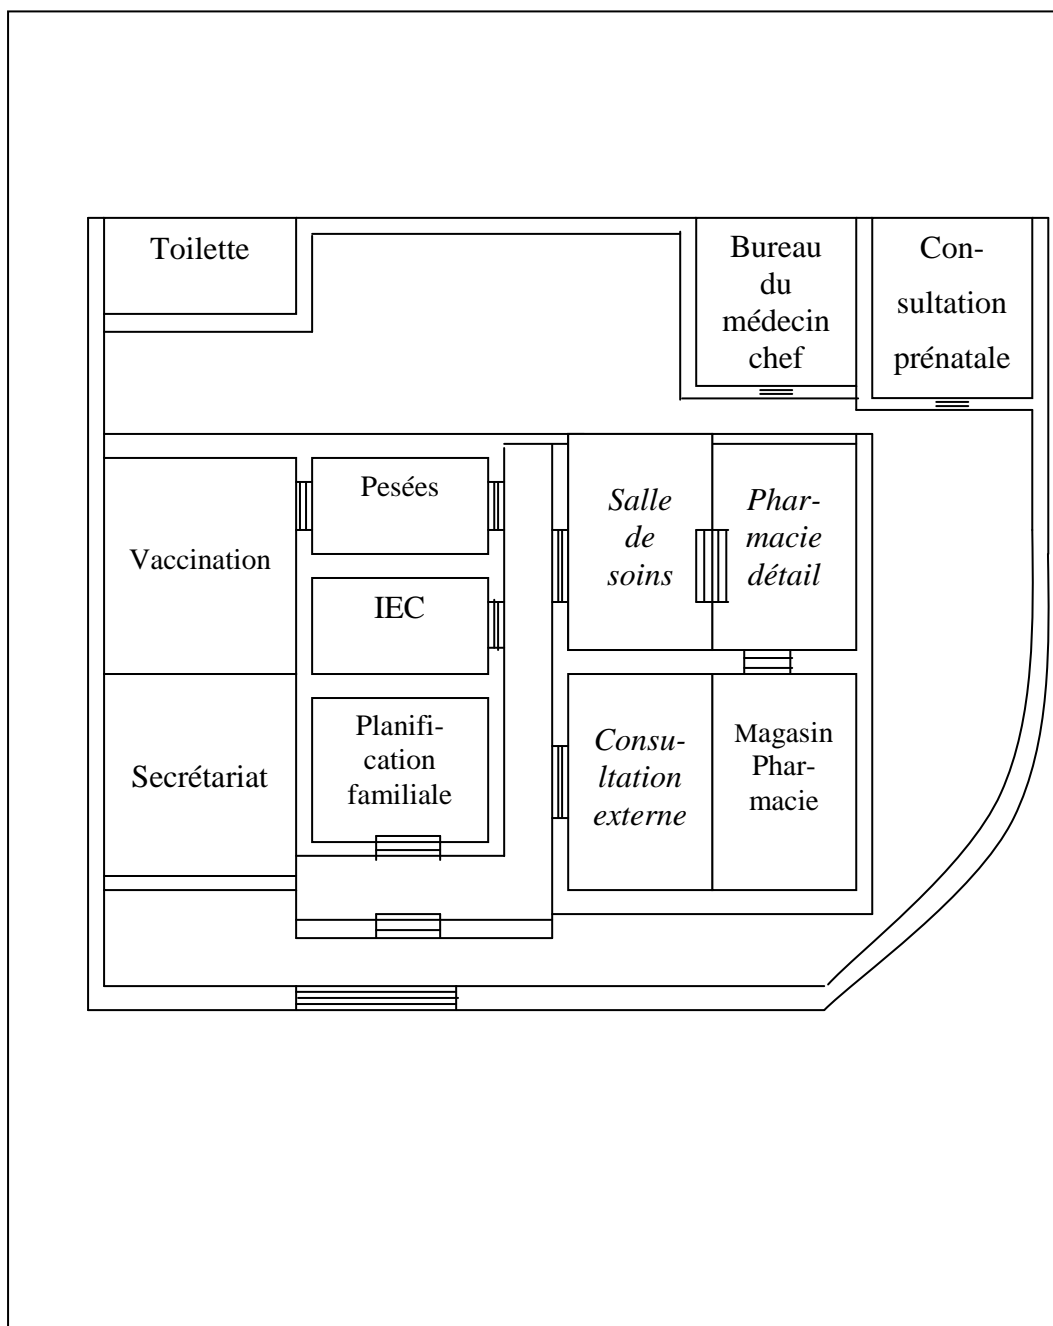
Plan schématique du CSB2 d'Antanimena.
